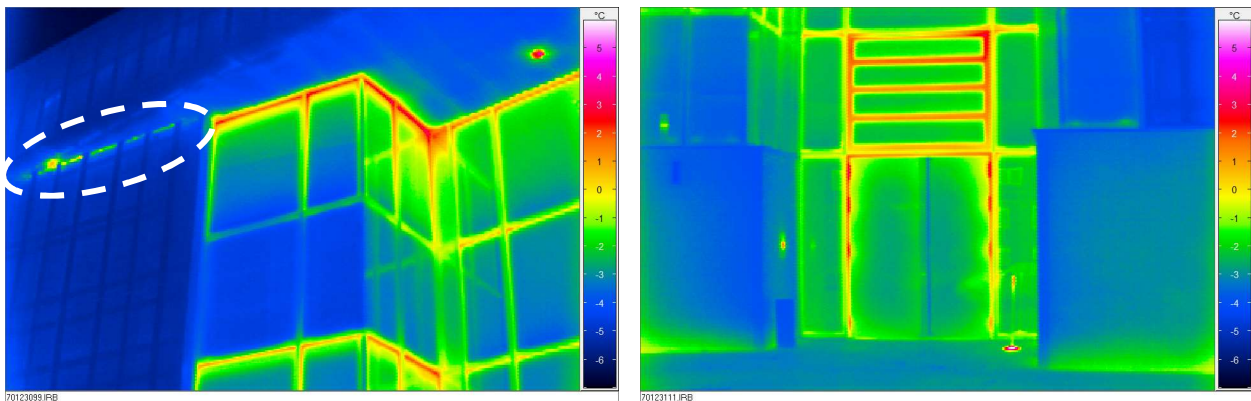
Außenthermographien der Süd-West Fassade. Rechts Detail mit der Fassadenöffnung zur Garage im EG.
